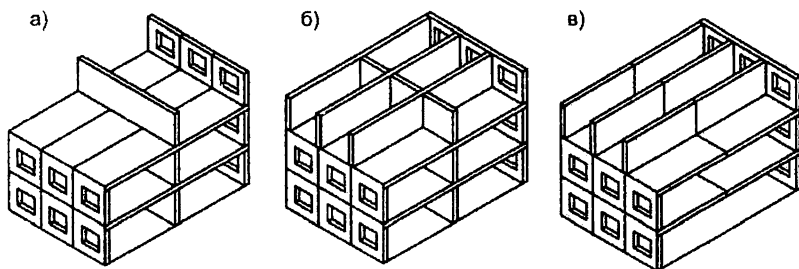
Схемы крупнопанельных бескаркасных зданий:
